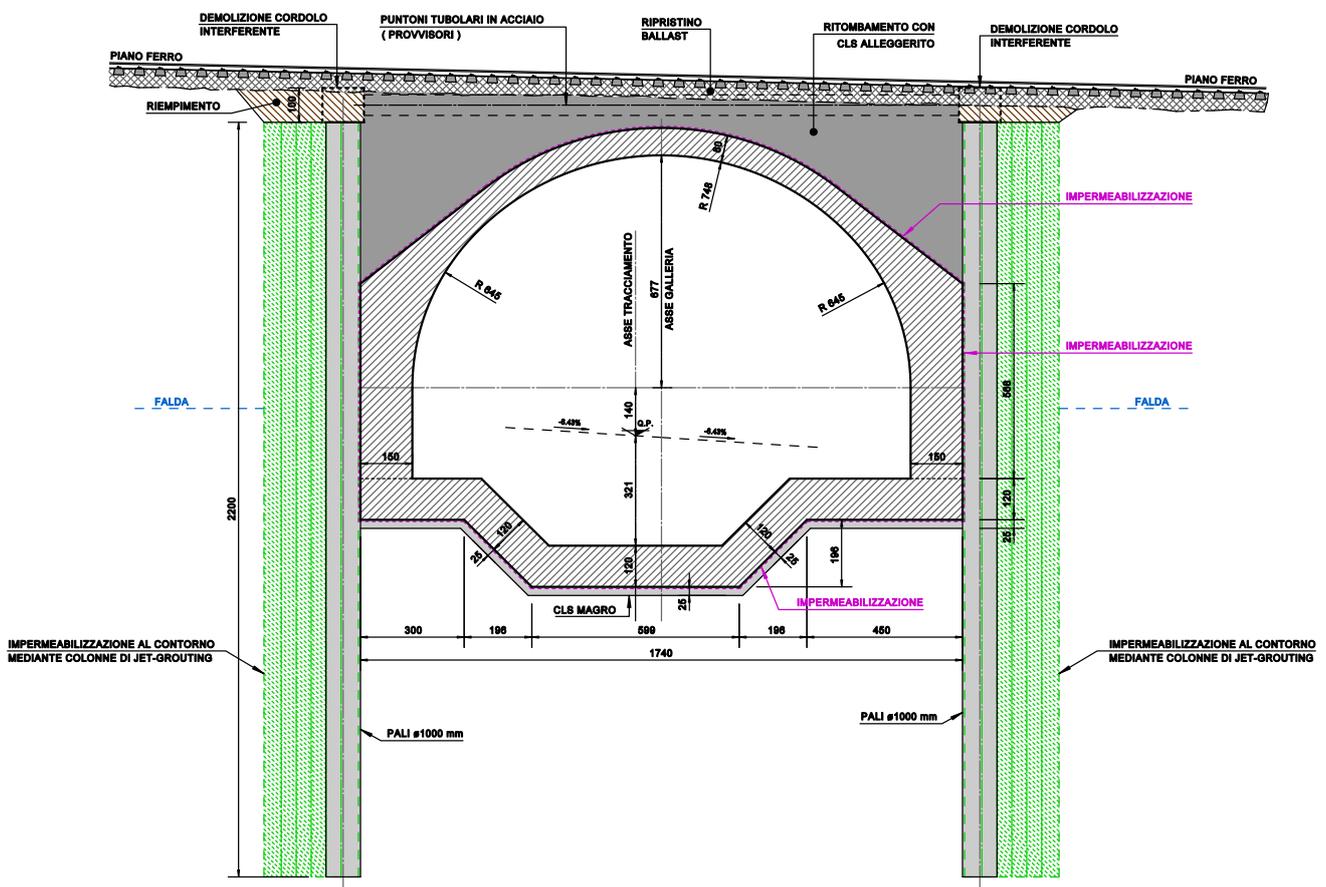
Galleria Artificiale SUD – Sezione sottoattraversamento ferrovia
